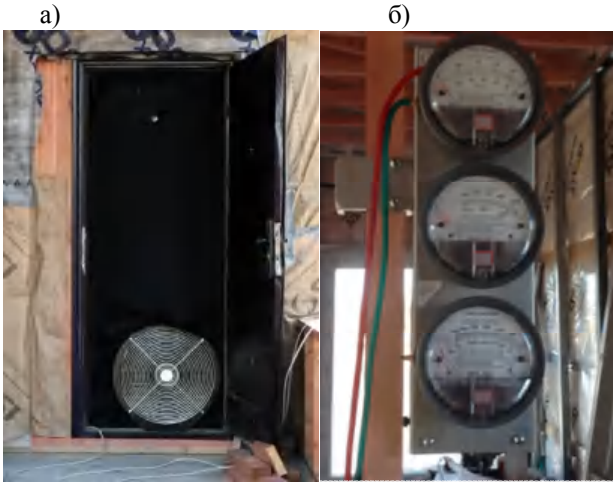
Обладнання для проведення Blower Door тесту / Equipment for Blower Door test
